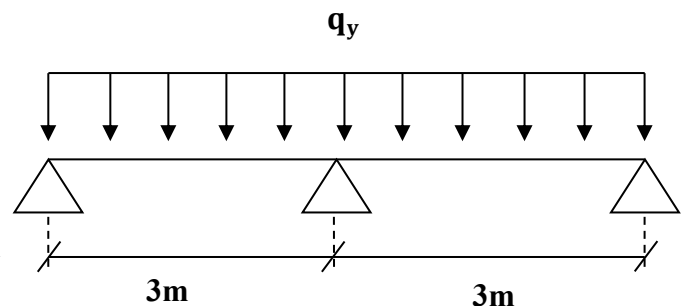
Actions sur la lisse de bardage dans le plan (Y-Y)
